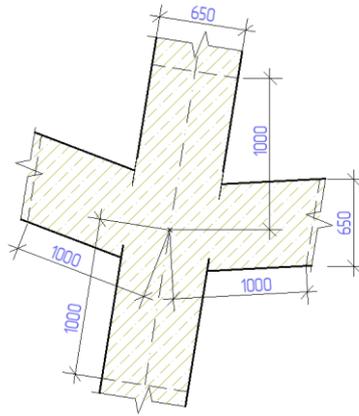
Обеспечение необходимой площади перекрестным ленточным фундаментом.
